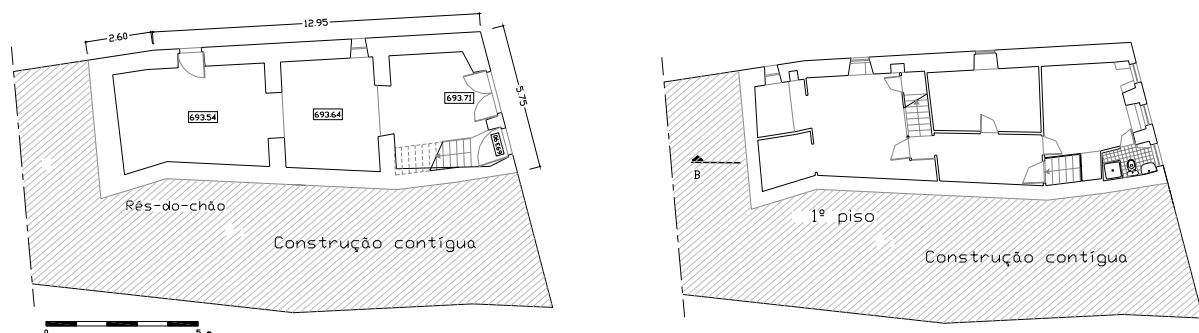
Configuração em planta (rés-do-chão e 1º piso elevado)
